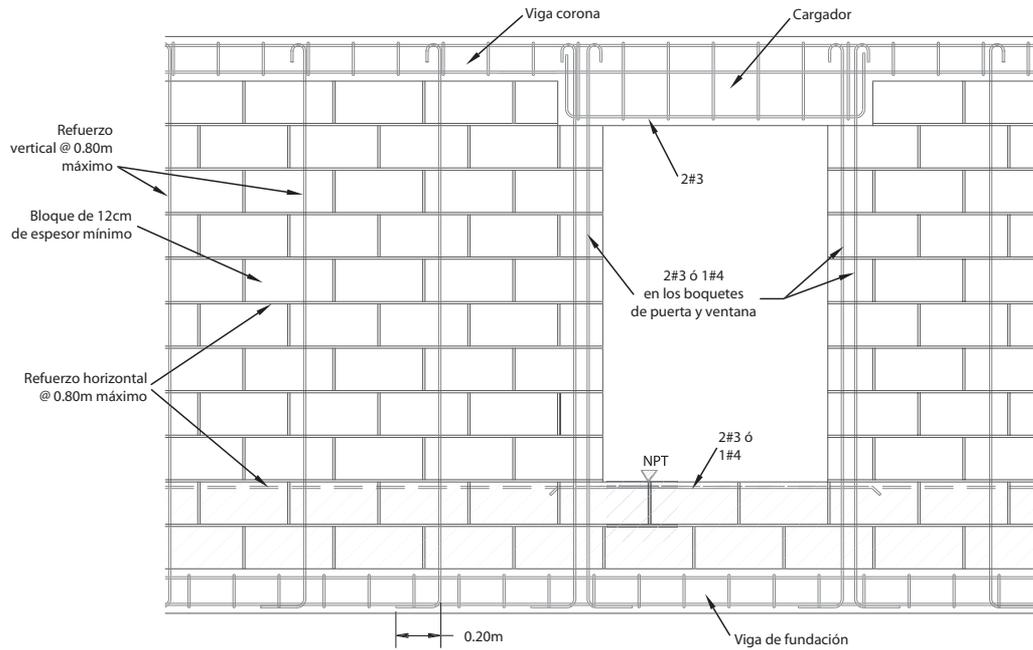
Elevación de pared de mampostería con refuerzo integral.
